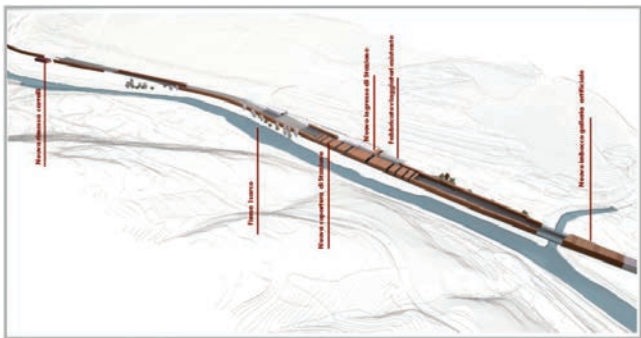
Opere presso la stazione di Ponte Gardena: modello tridimensionale.
